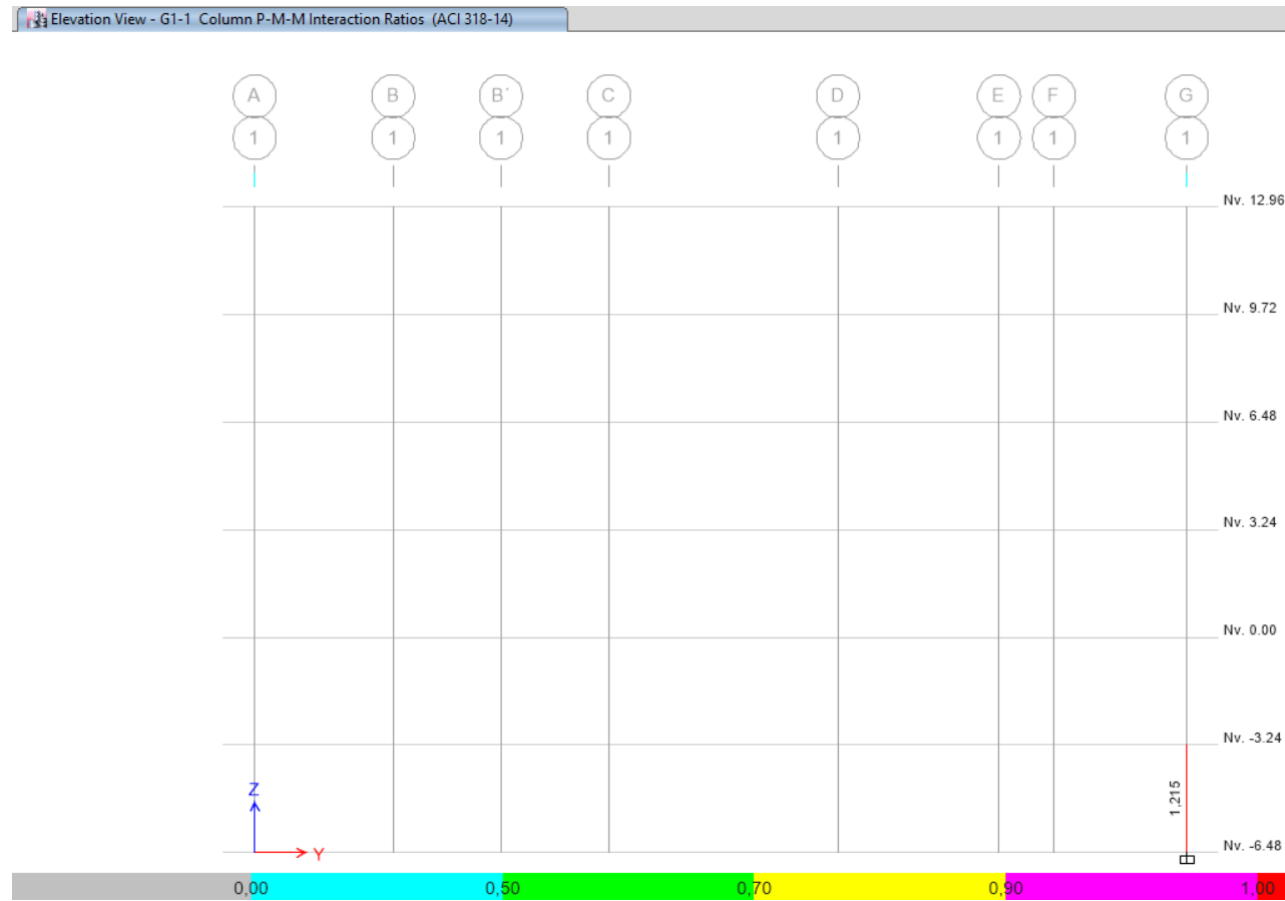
Vista en elevación de la demanda/capacidad en columnas, pórtico eje G.
